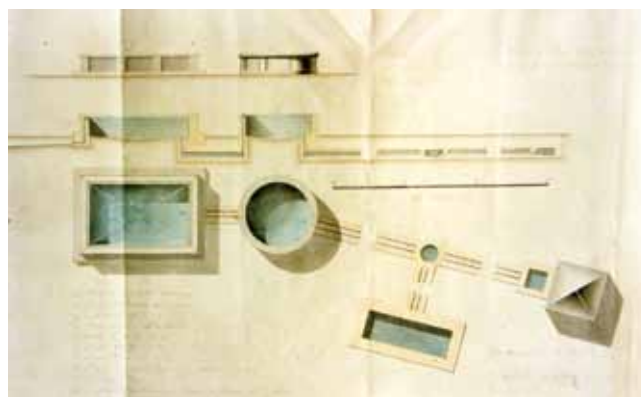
Proyecto de lavadero y abrevadero en la plaza del Seis de Agosto, Gijón. (NR)
